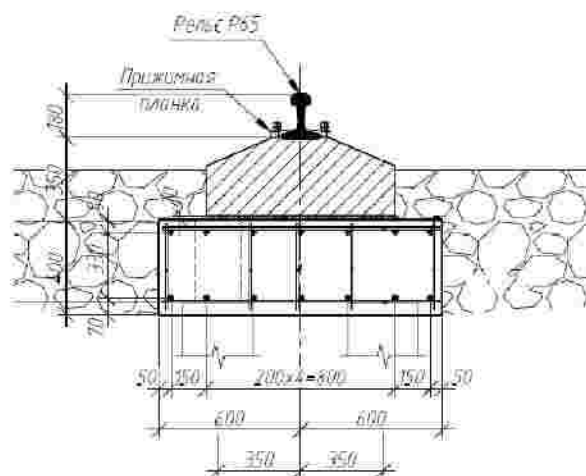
Узел кранового пути на железобетонном фундаменте
